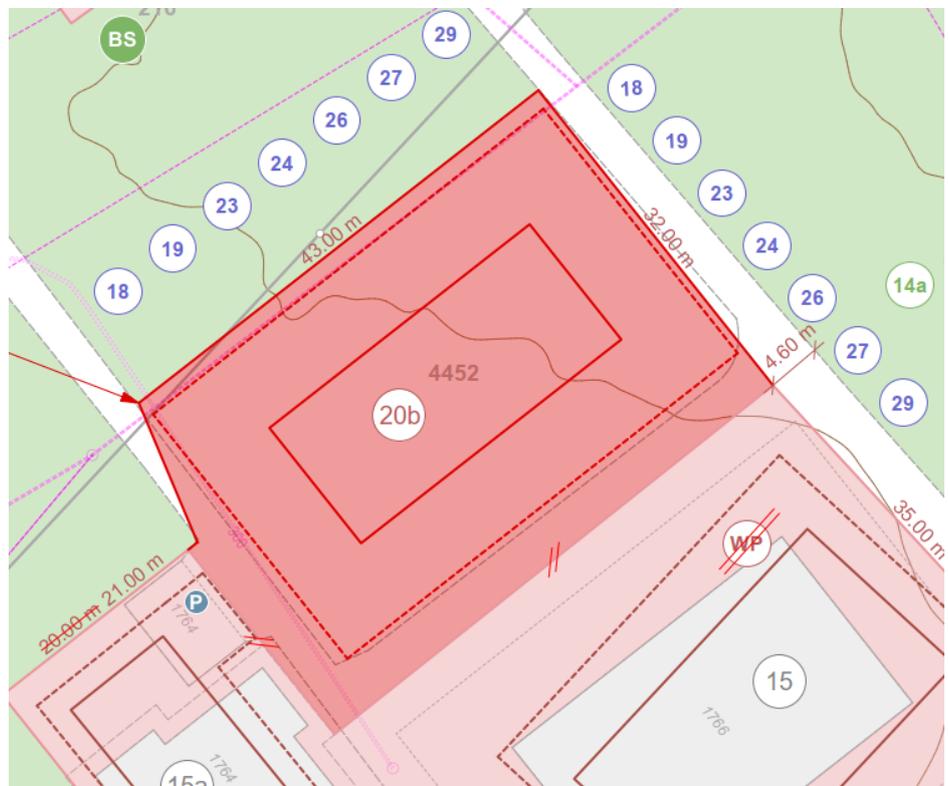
Planausschnitt Situationsplan - Änderungen
